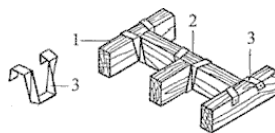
Установка ригелей: 1 – балка перекрытия; 2 – ригель; 3 – металлический хомут.
